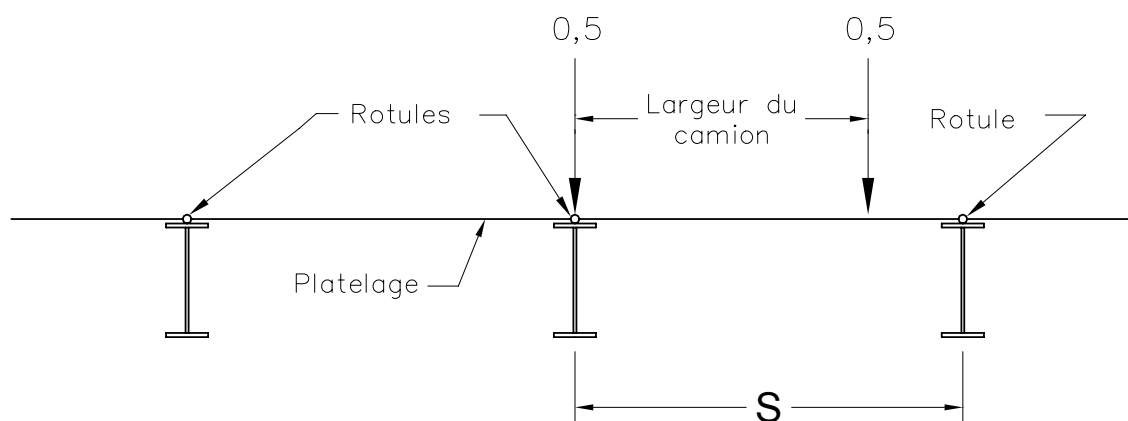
Coupe transversale du pont – répartition statique à une poutre intérieure
